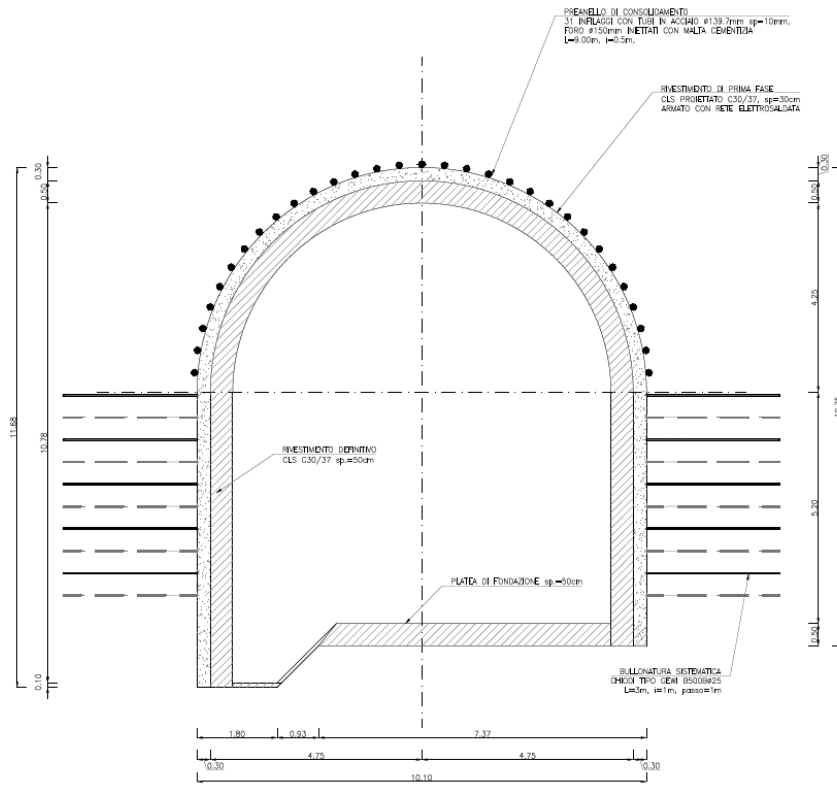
Sezione tipo GV-Imb: geometria del cavo e interventi di sostegno, sezione trasversale
